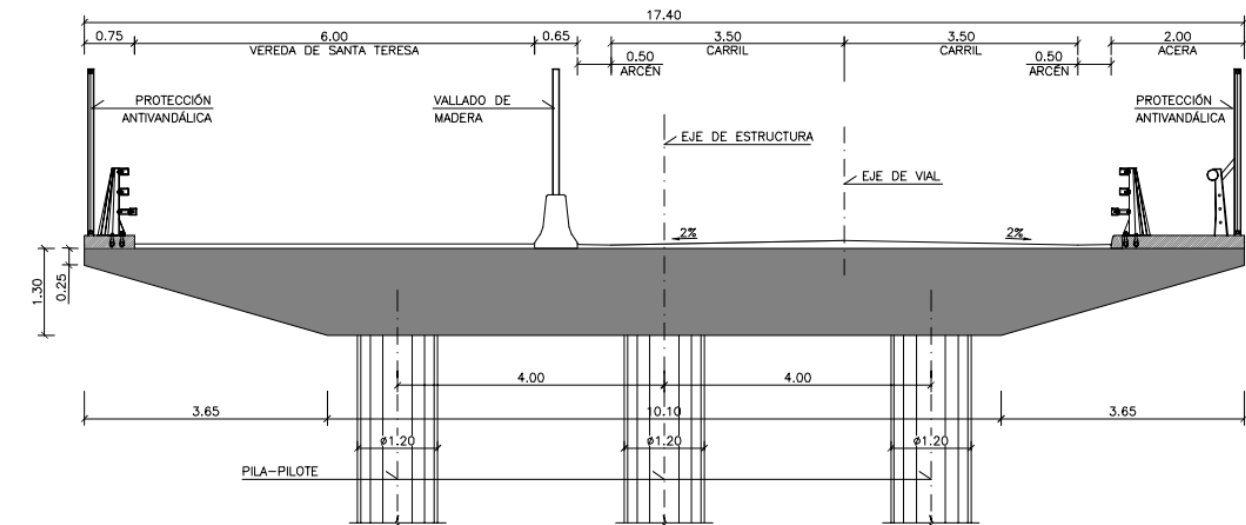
SECCIÓN TIPO PS ACCESO ESTACIÓN DE ELCHE Y COLADA DE SANTA TERESA P.K. 2+990
